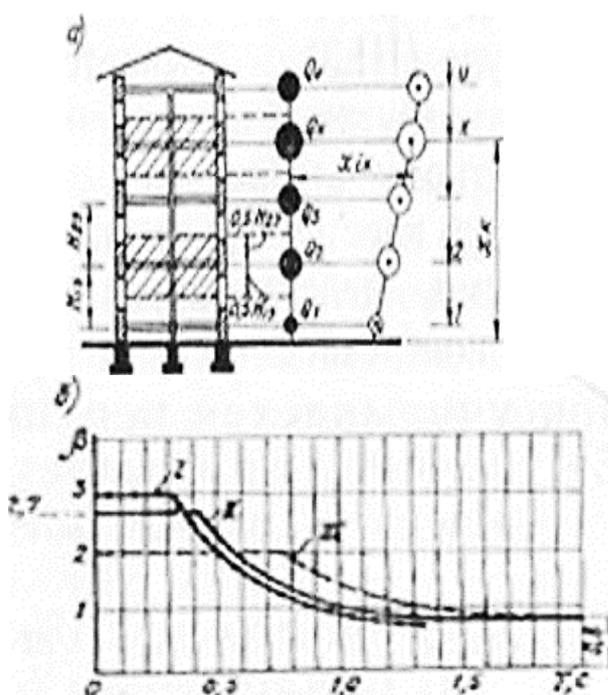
Схемы к определению на здание сейсмических нагрузок.
